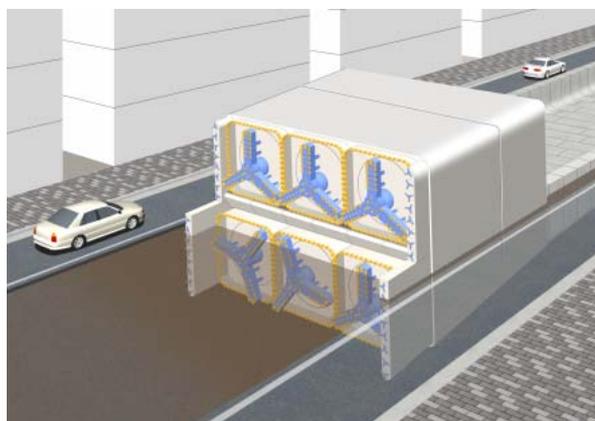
URUP工法の概要図 (アプローチ部の施工)
